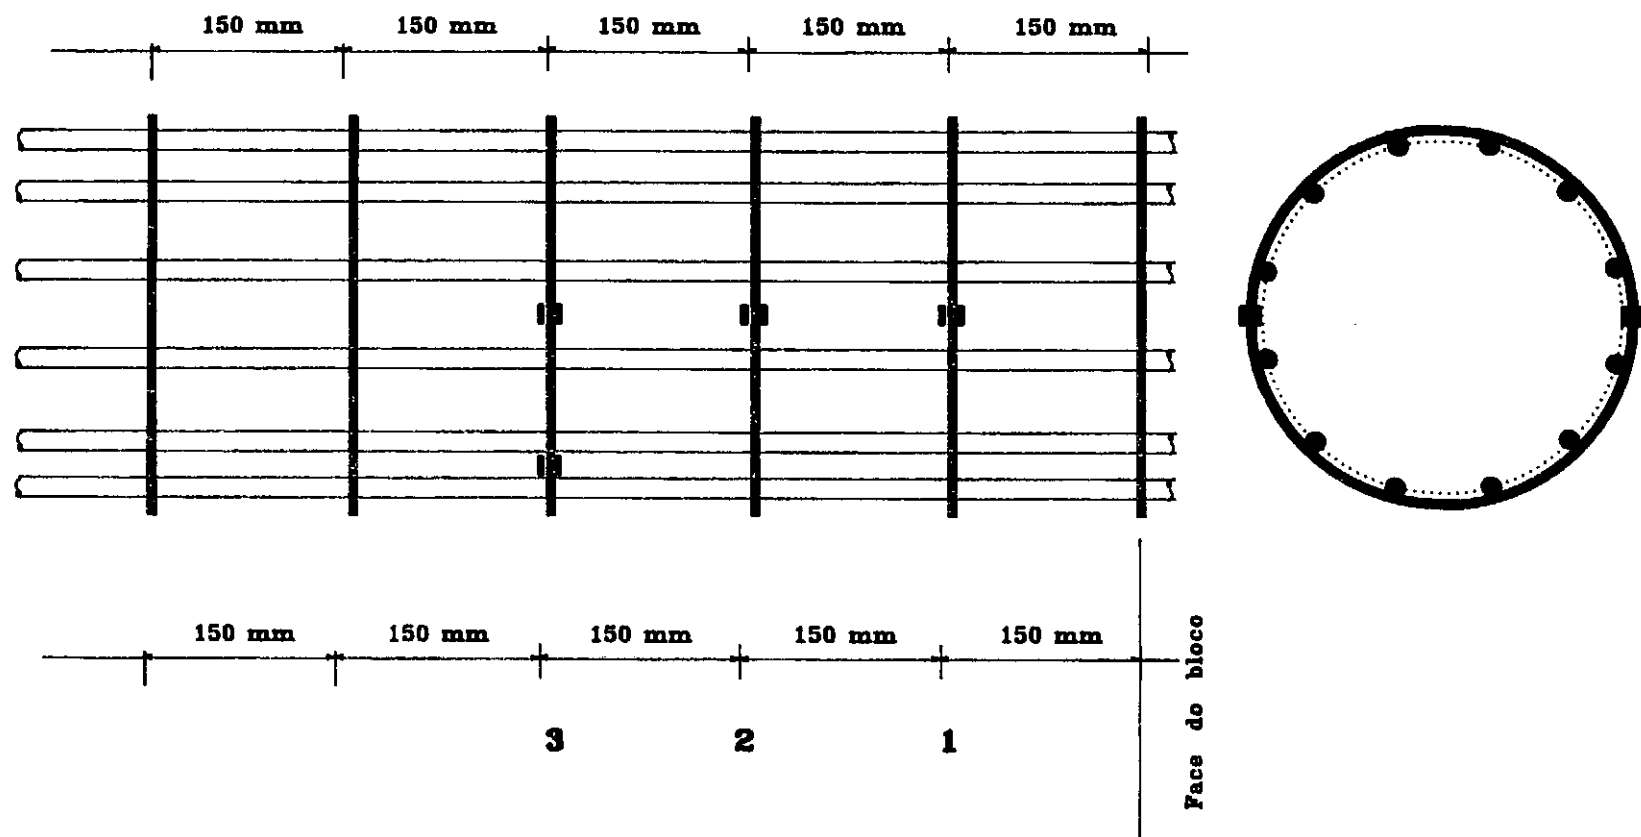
POSIÇÃO DOS EXTENSÔMETROS ELÉTRICOS NAS BARRAS TRANSVERSAIS
